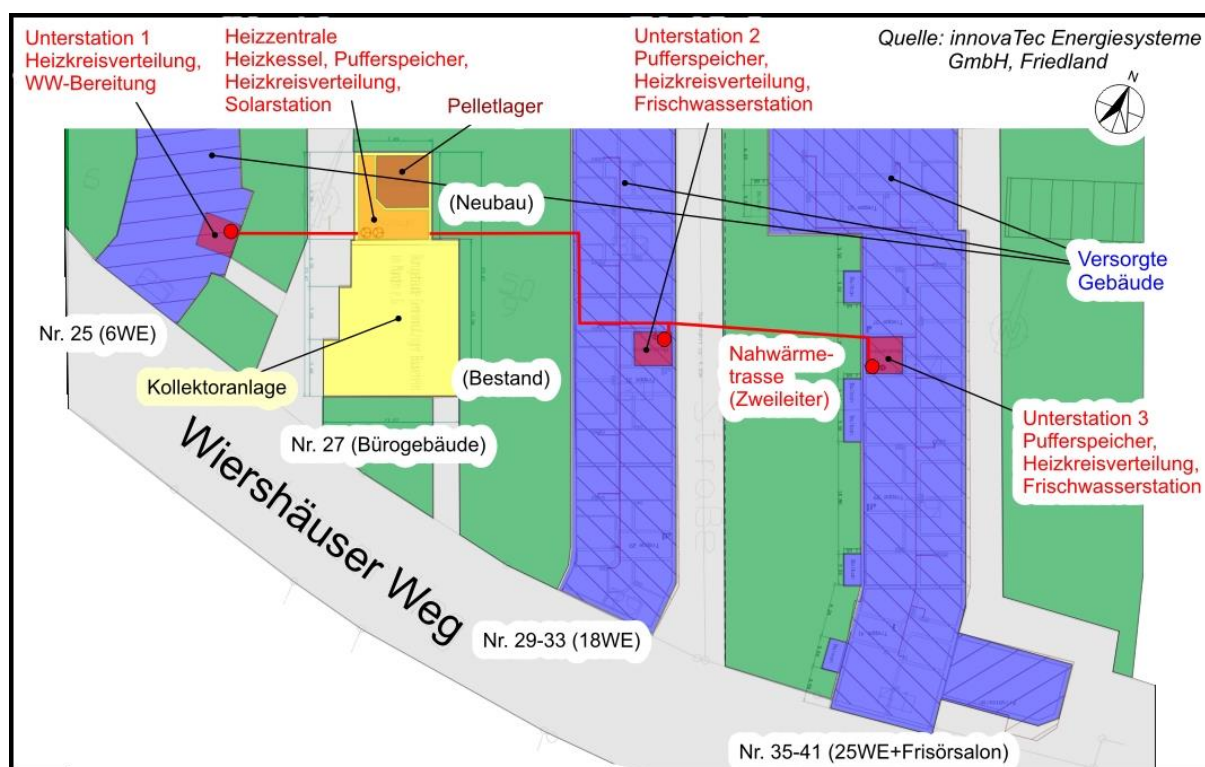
Lageplan Hannoversch Münden, Wiershäuser Weg 25-41
